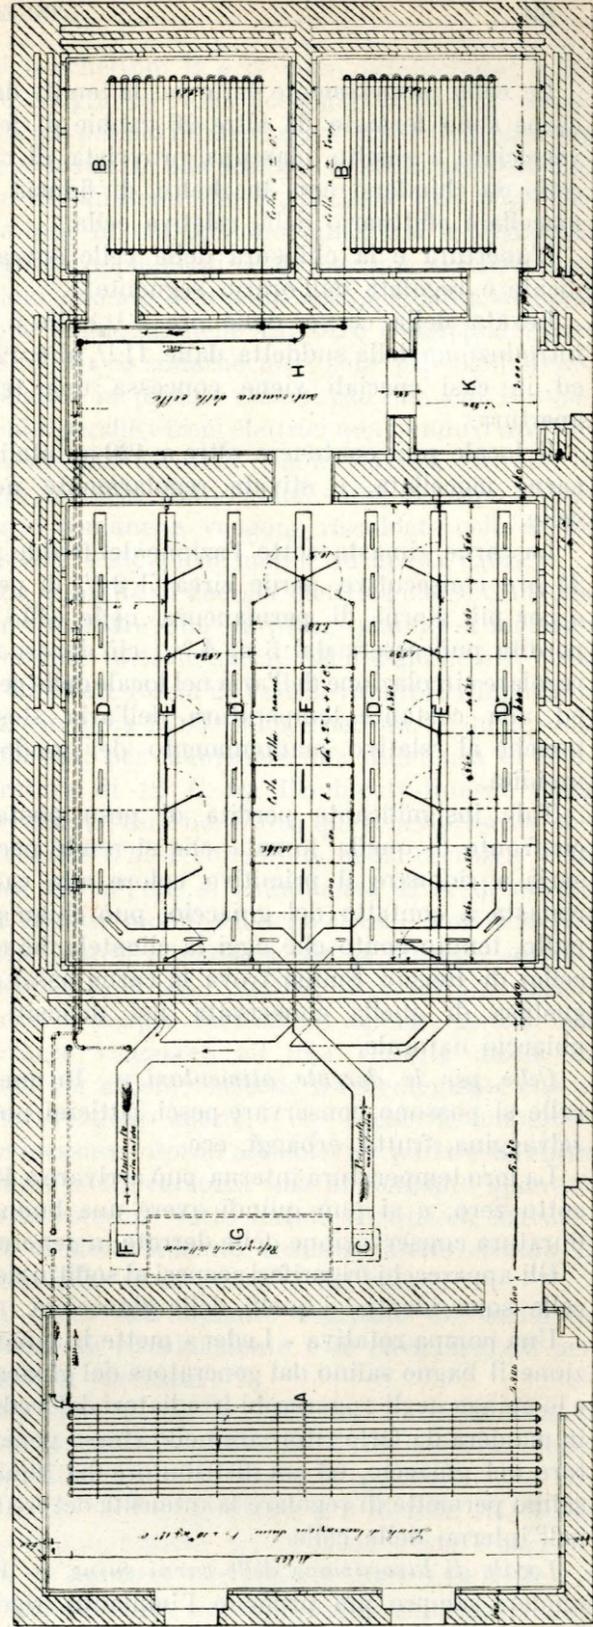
Pianta del piano superiore (Scala 1:150).
